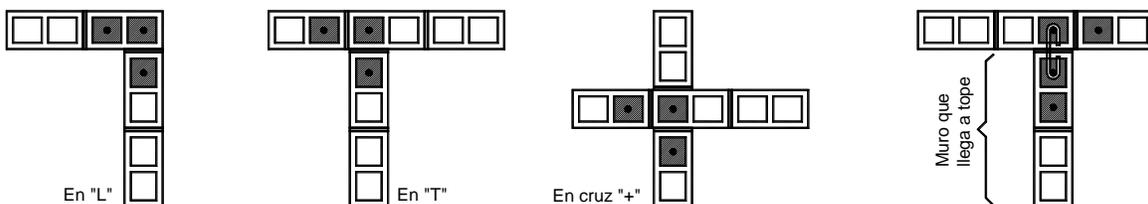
Refuerzo en los extremos de los muros e intersecciones
